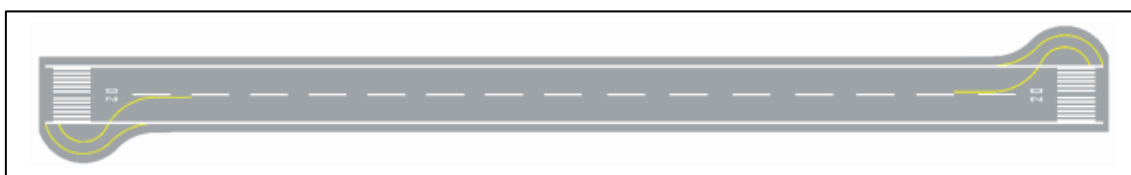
Disposição típica de uma área de giro de pista de pouso e decolagem.
